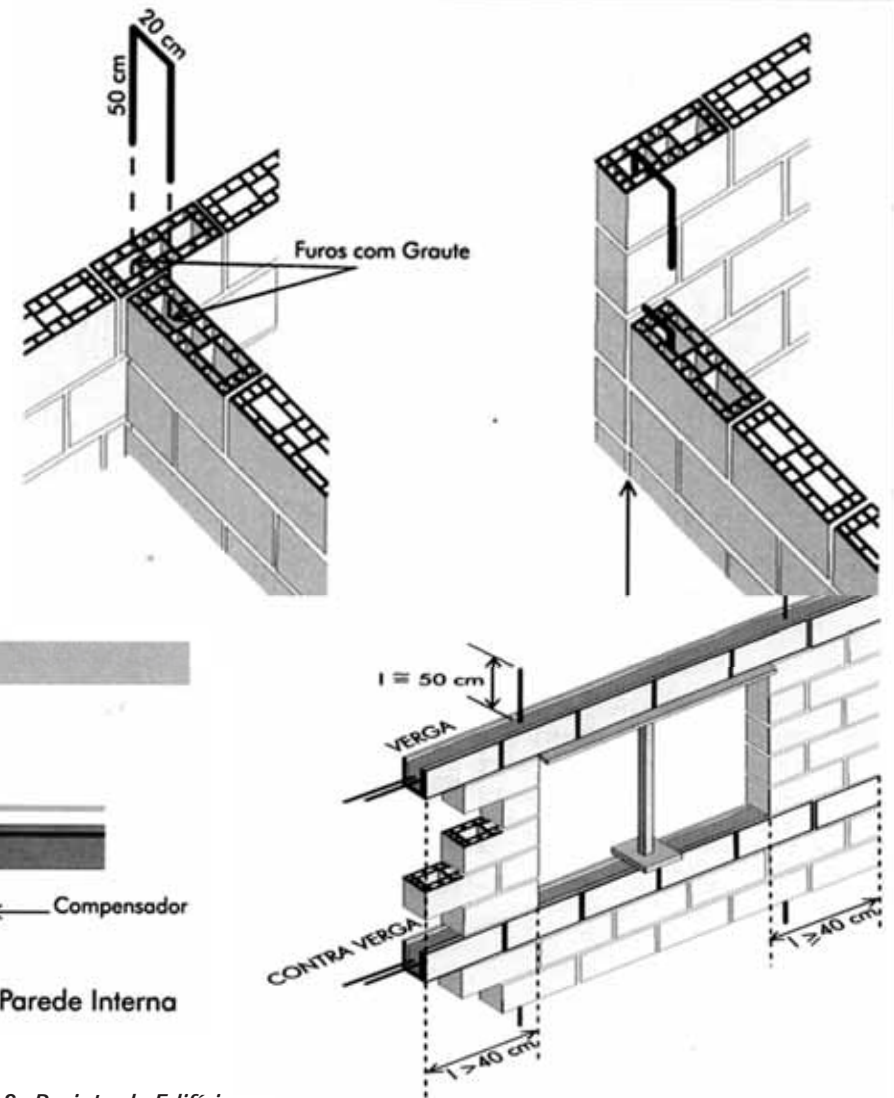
Detalhes alvenaria estrutural. Fonte: RAMALHO, M.A. & CORREA, M.R.S. *Projeto de Edifício. Alvenaria Estrutural*. Editora PINI. São Paulo, 2003
